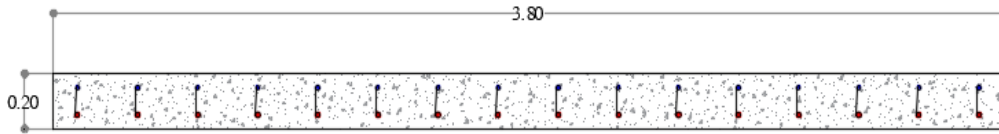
Armado del parapeto, análisis en sentido transversal (vista en planta)
